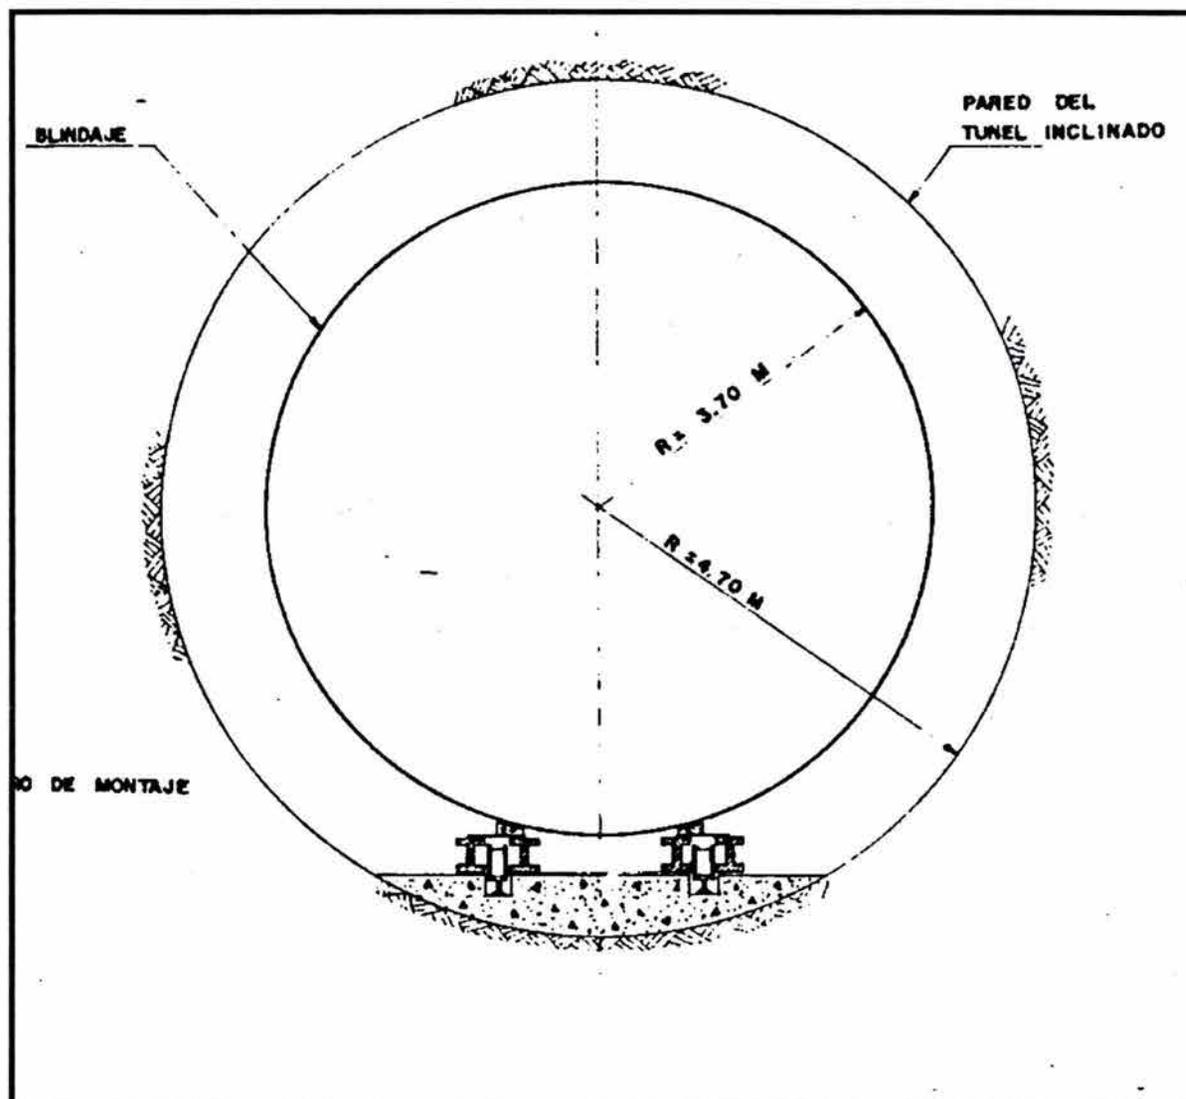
VISTA FRONTAL DE LA VÍA
